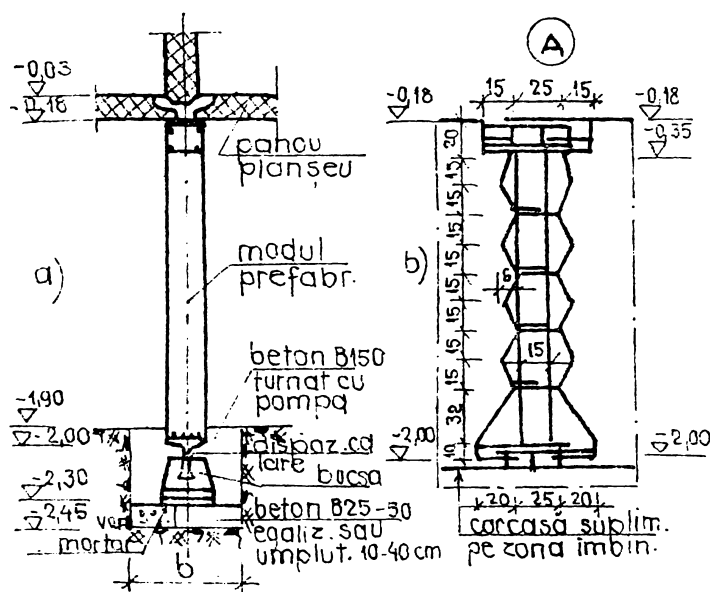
Secțiune verticală prin infrastructură și detaliu de îmbinare curentă a elevațiilor: a-secțiune verticală; b-îmbinarea modulelor pentru elevații;
